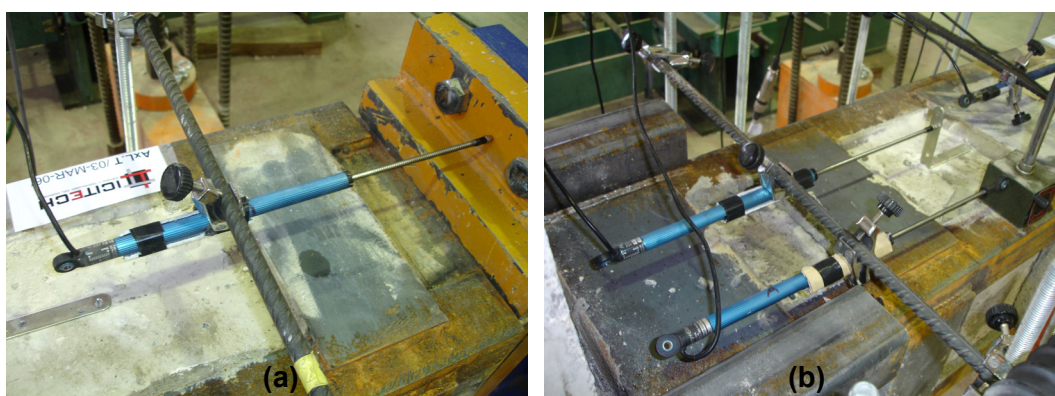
LVDTs. (a) Medida del acortamiento de la probeta; (b) Medida del deslizamiento relativo entre el refuerzo y el tramo de soporte
